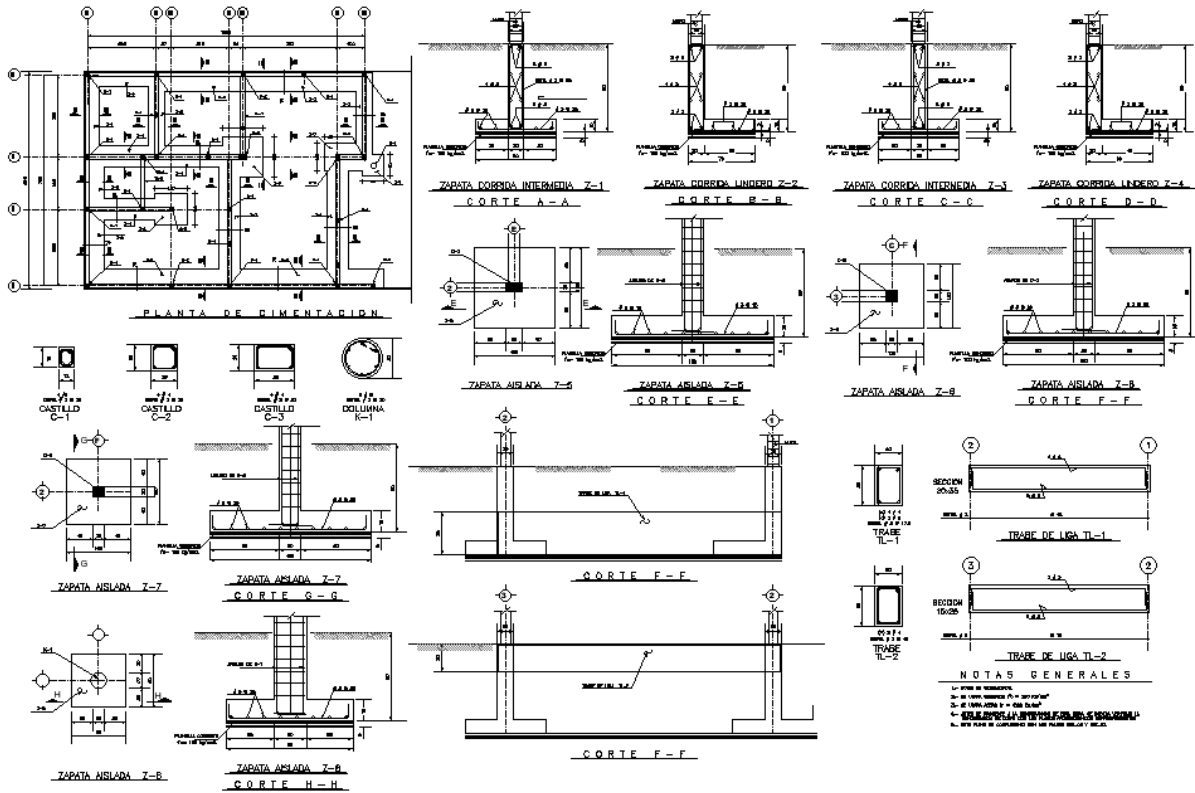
Plano de proyecto estructural de cimentación. Autoría propia
